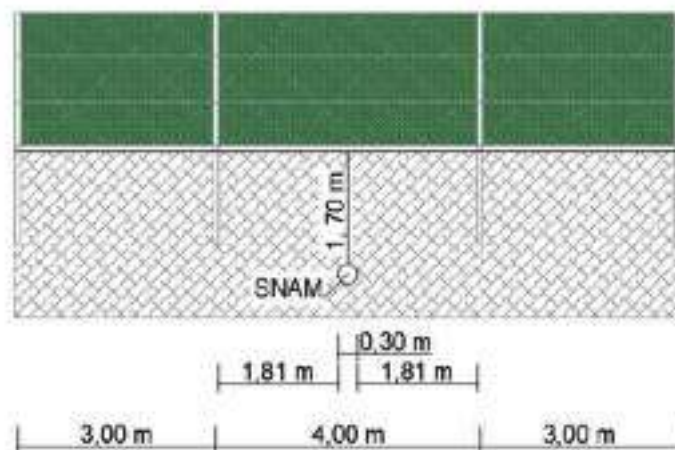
attraversamento della fascia di rispetto con la recinzione nella zona 4.
